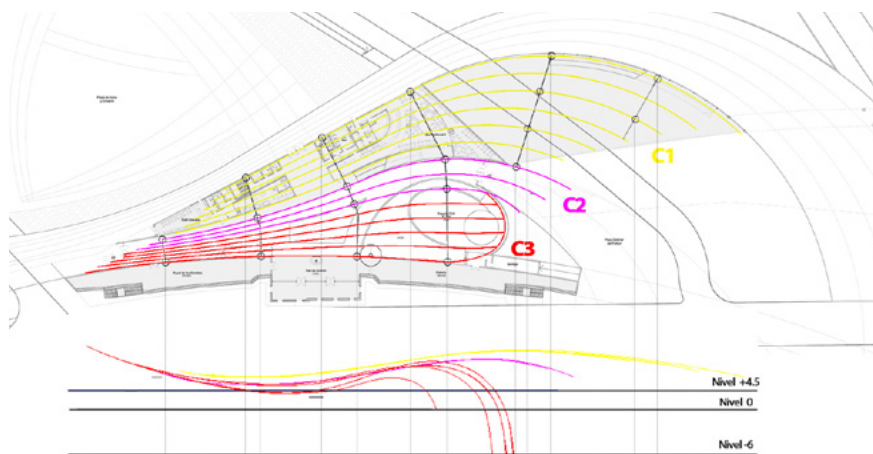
Planta Esquemática 3 cubiertas y posible posición apoyos.
